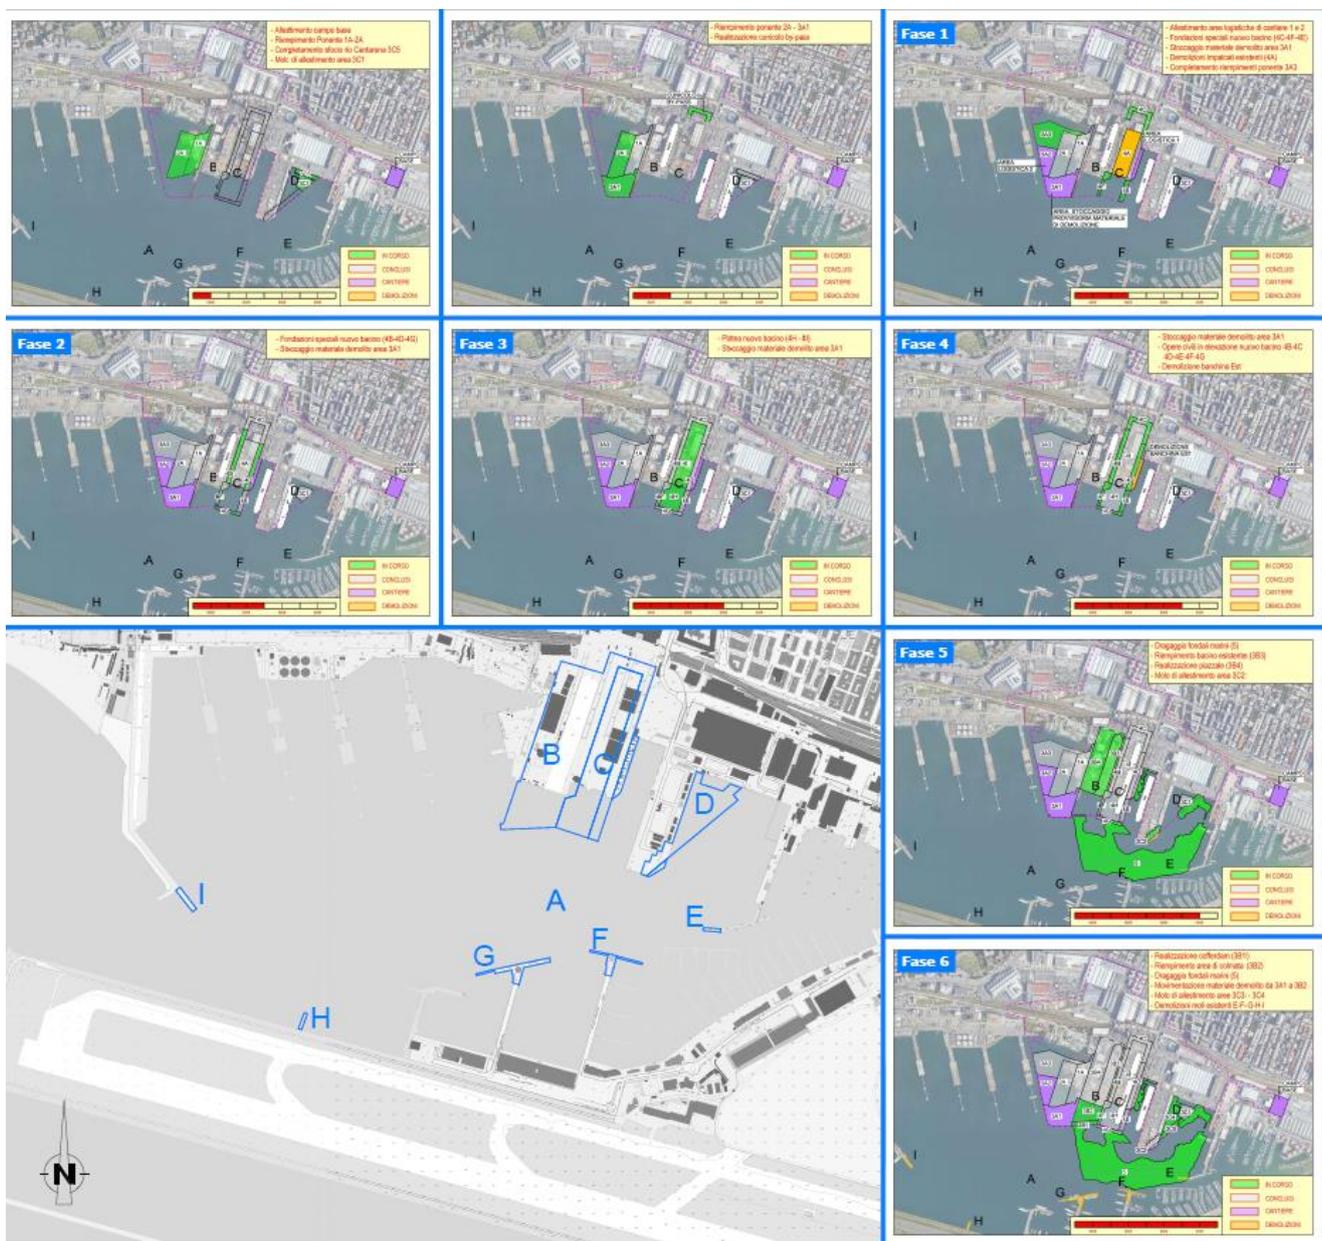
Stralcio tavole delle aree e fasi cantiere
